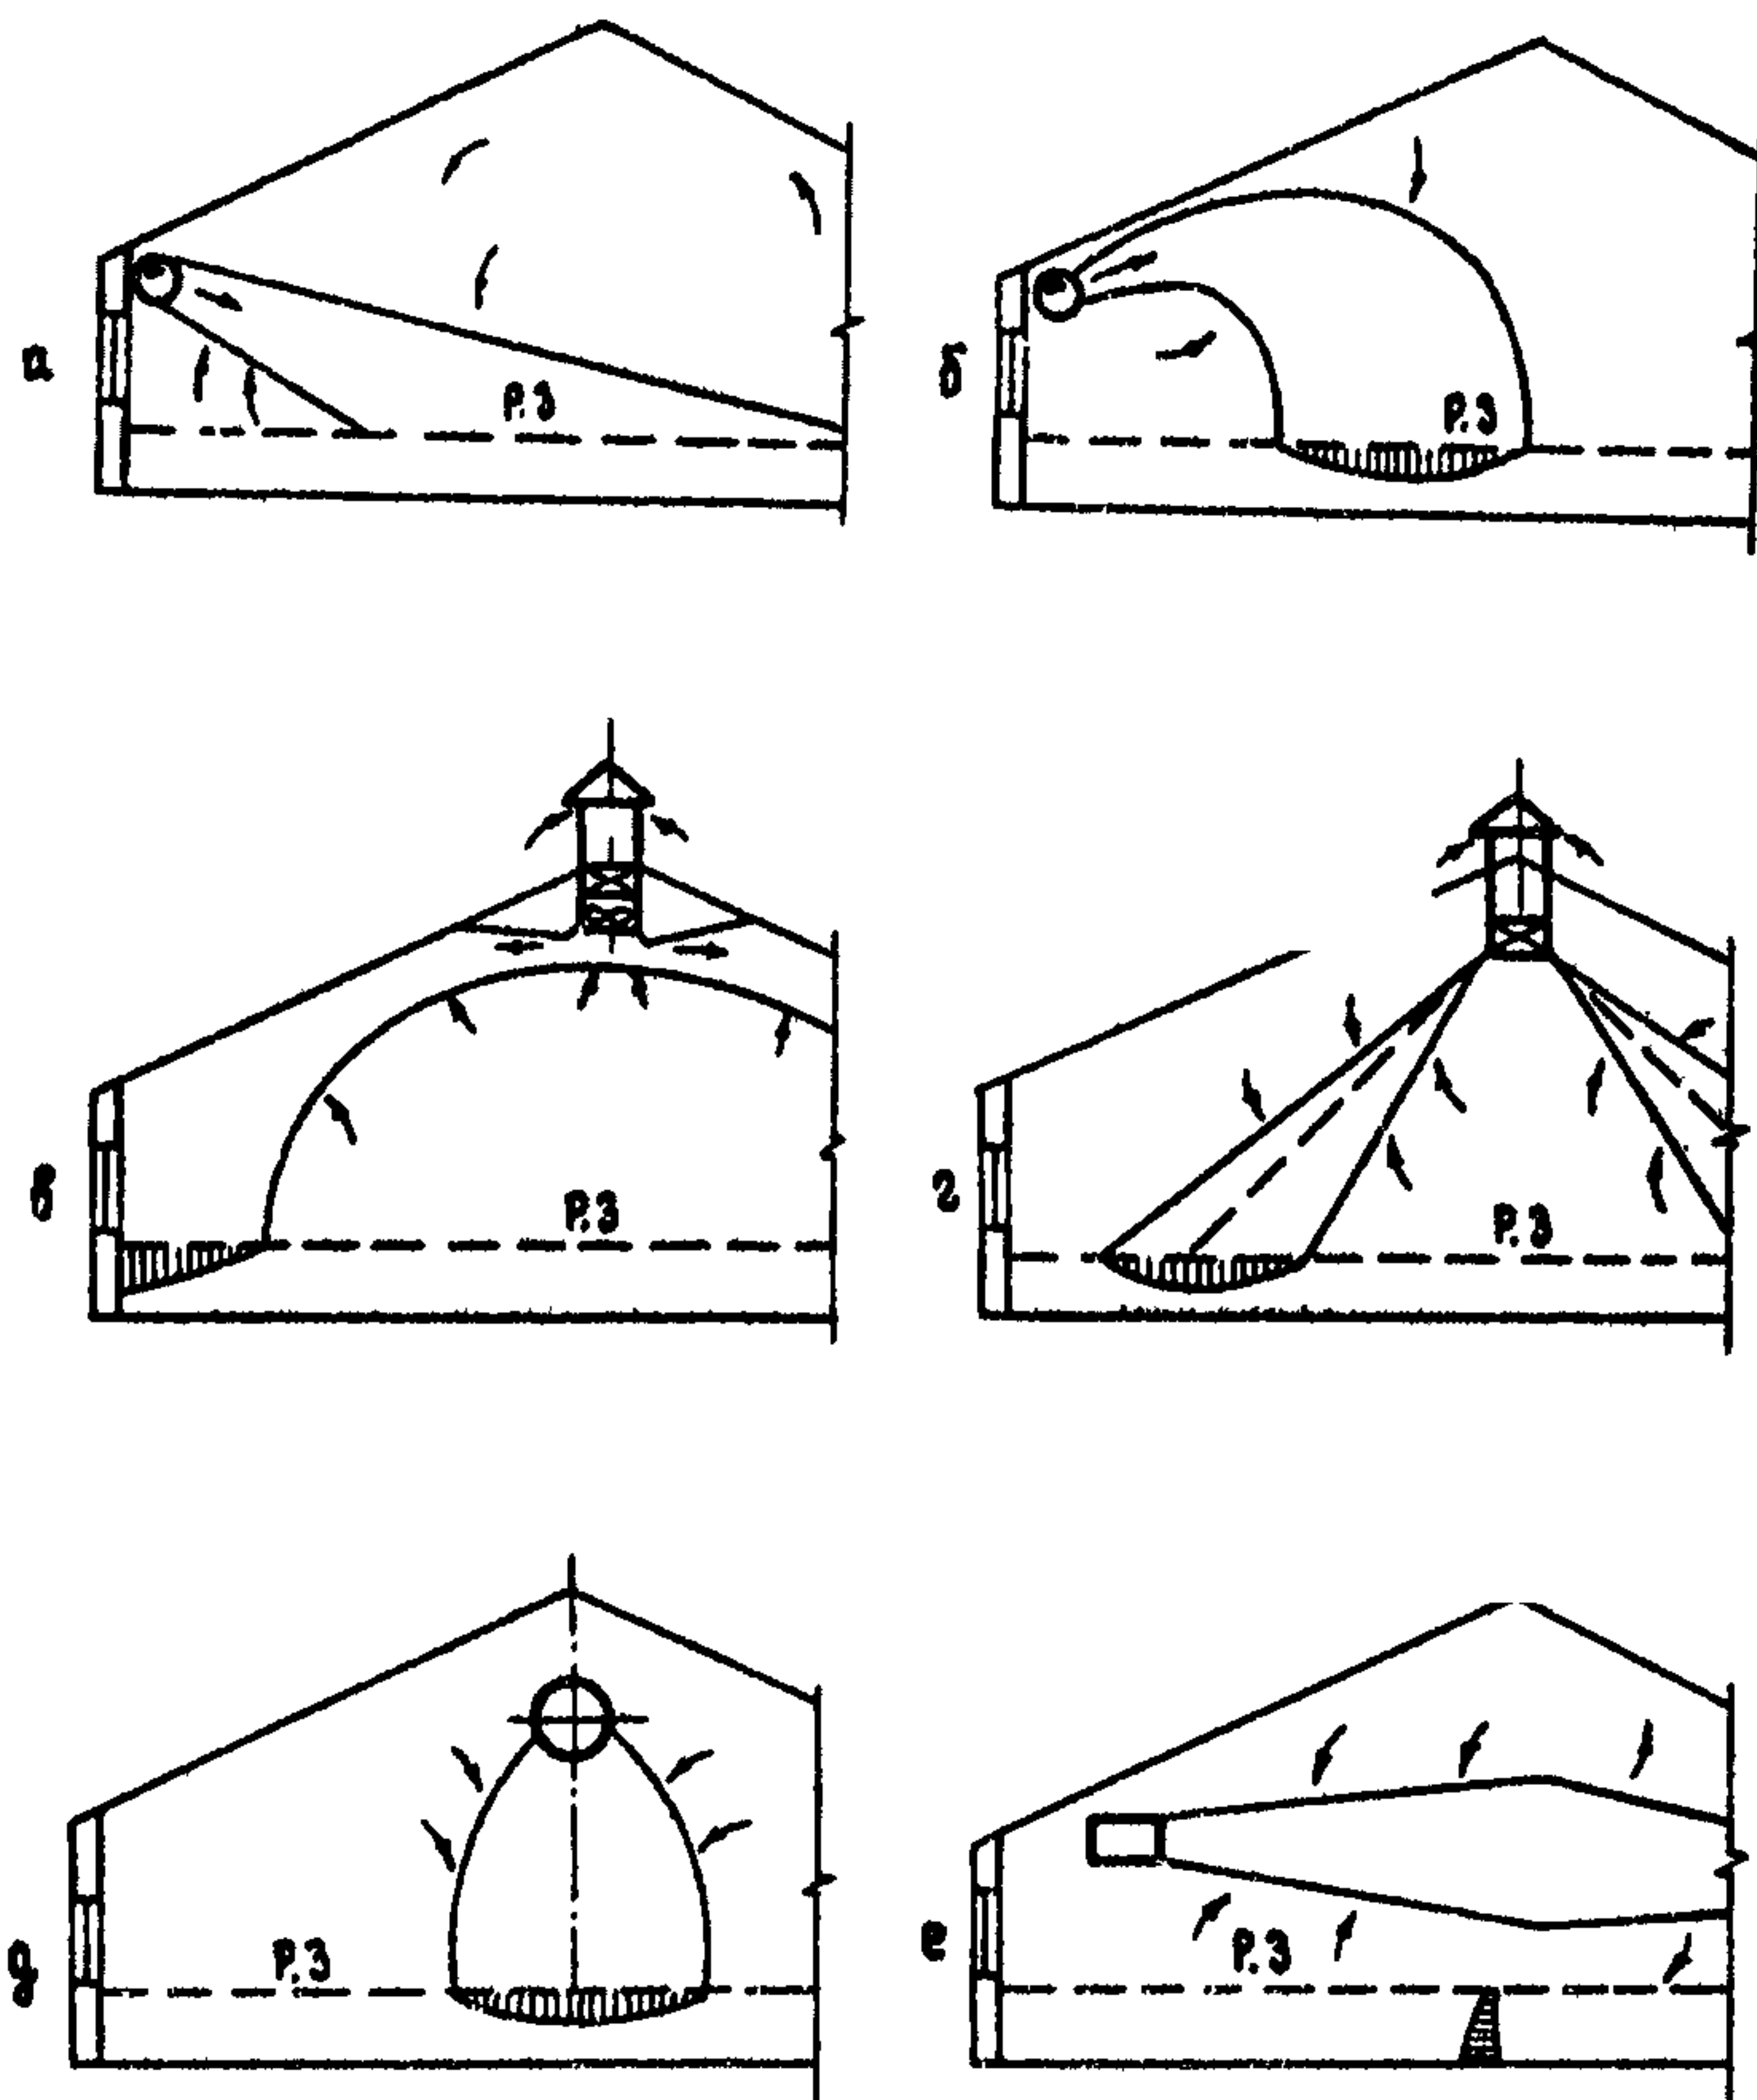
Рис. I. Основные схемы организации воздухообмена в животноводческих помещениях приточными вентиляционными струями:
